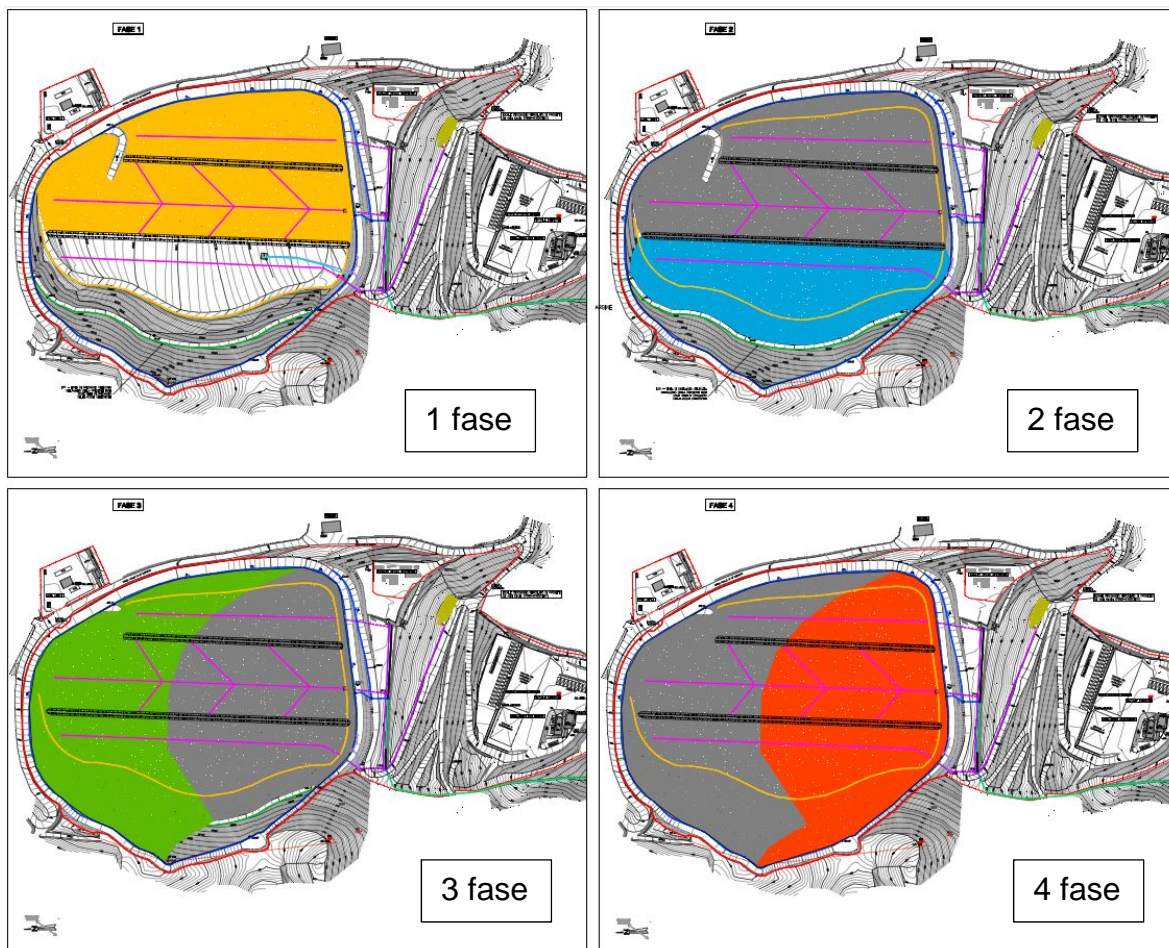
estratto della “Planimetria delle fasi di abbancamento” approvata
